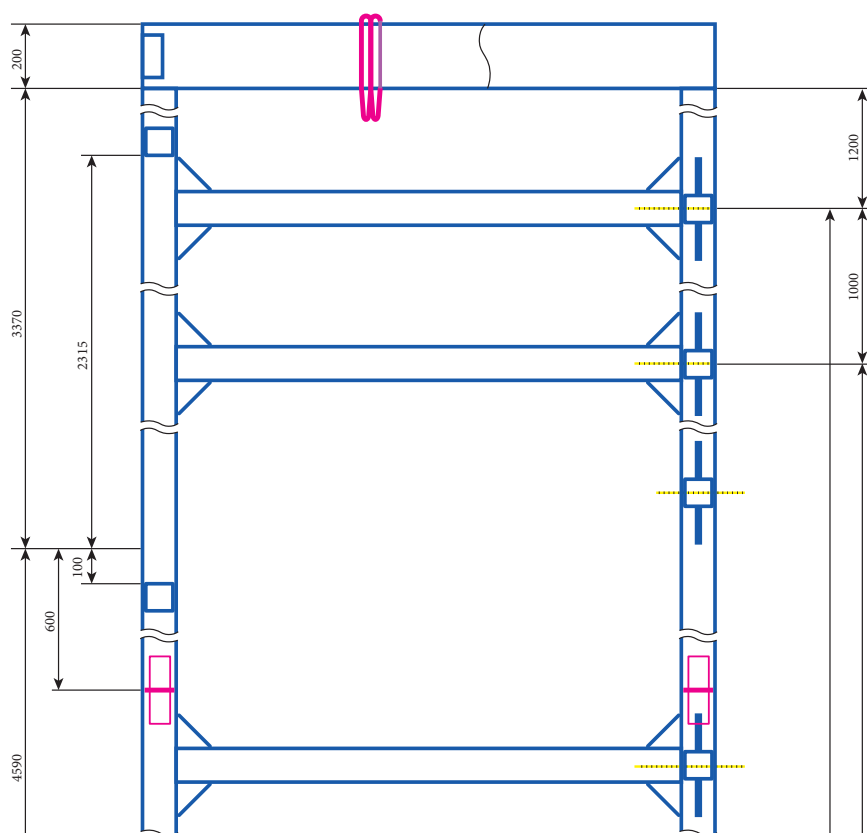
Жесткие узлы безраскосного каркаса
